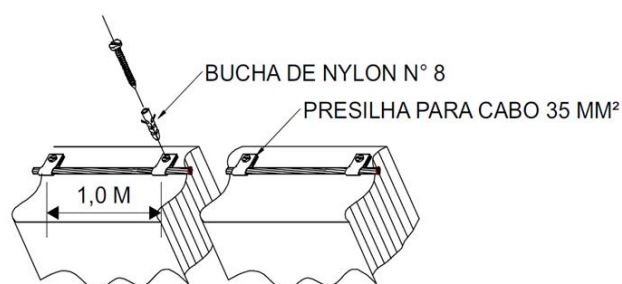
Fixação dos condutores em anel na parede em alvenaria.
